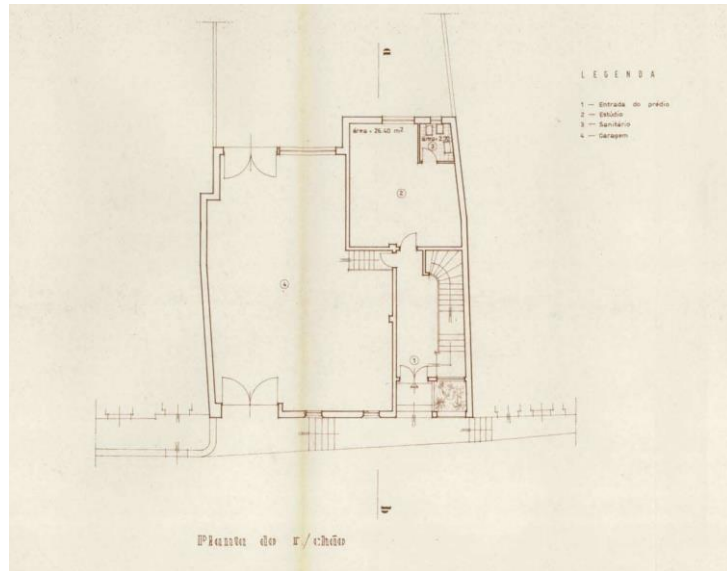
Planta de Levantamento, r/chão, fonte Câmara Municipal de Leiria
